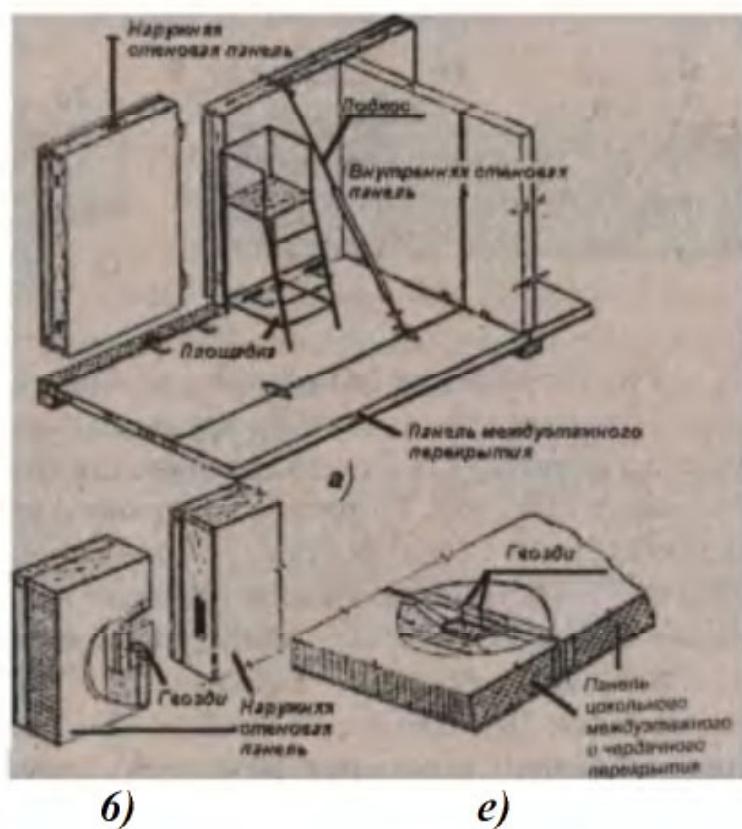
Схема монтажа и организации рабочего места при установке, выверке и временном креплении наружных стеновых панелей: а - схема монтажа; б - узел крепления стеновых панелей; в - узел крепления панелей перекрытия
